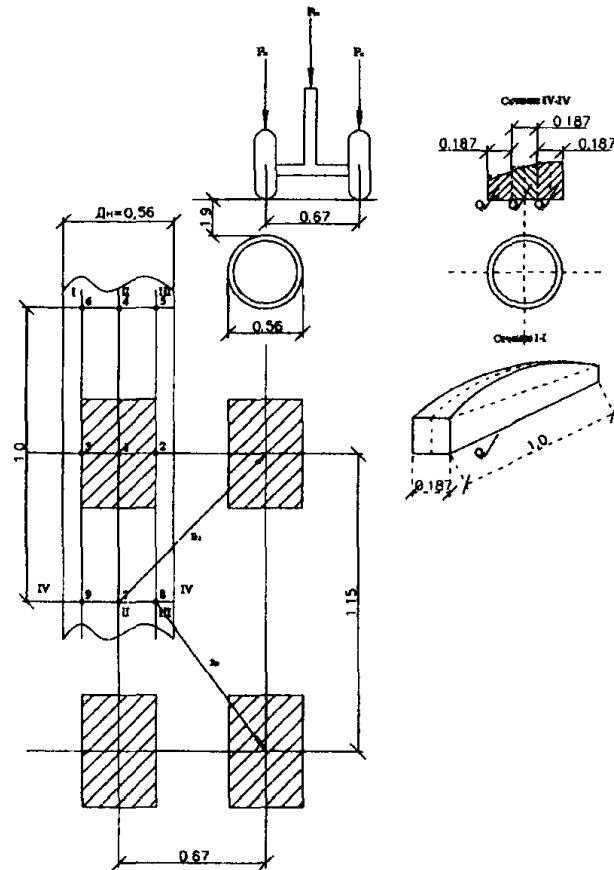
Расчет нагрузки на трубу от колес самолета:
